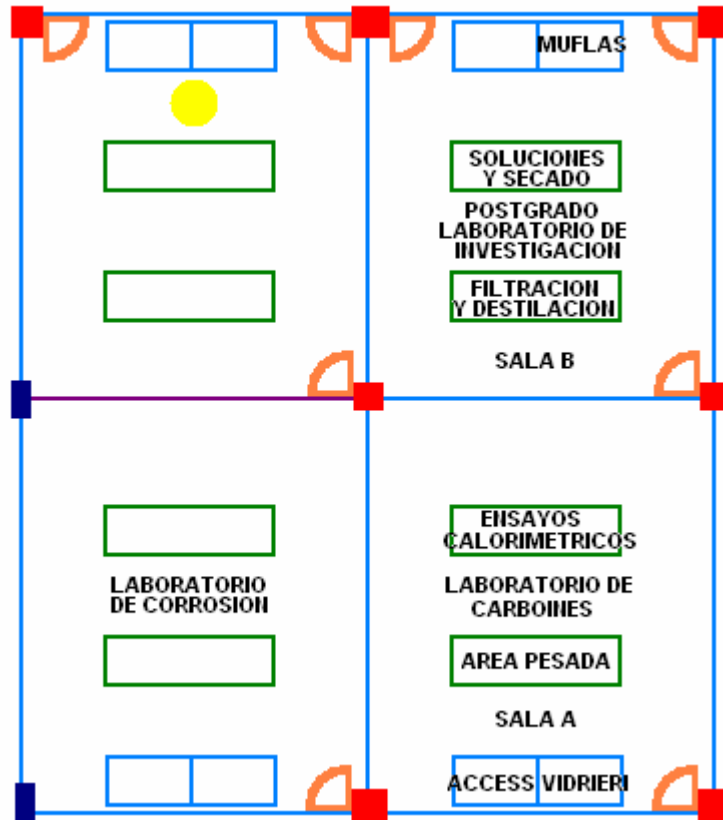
Plano 3. Edificio Planta de Aceros - Distribución Física Laboratorio Pirometalurgia
